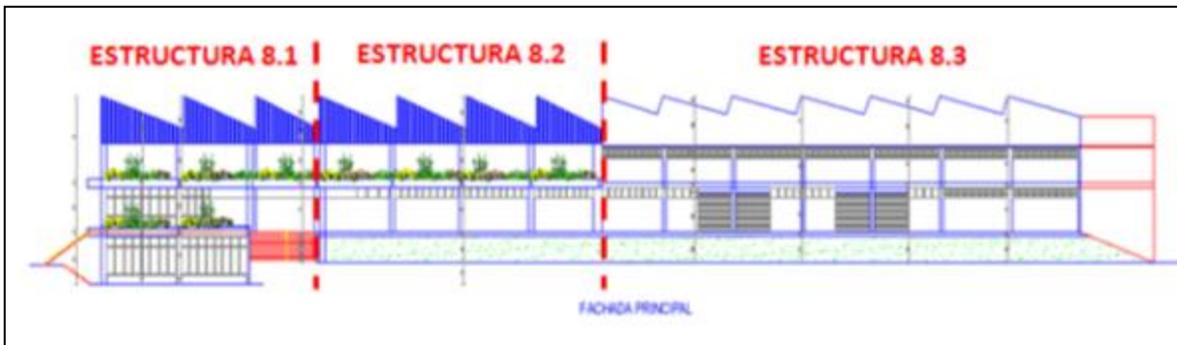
Estructura 8. Fachada principal y división de estructuras
